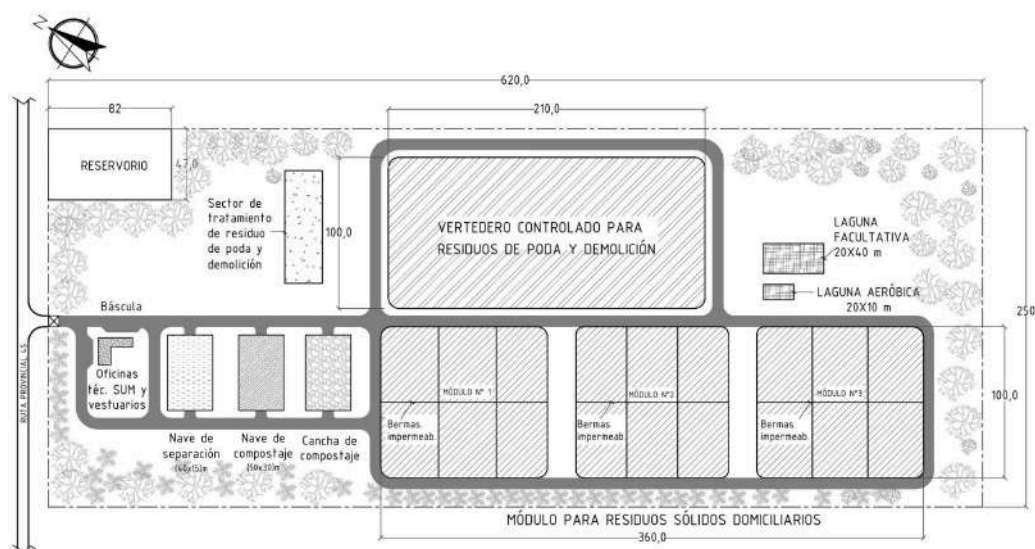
Layout propuesto para el GIRSU (Fuente: Elaboración propia)
